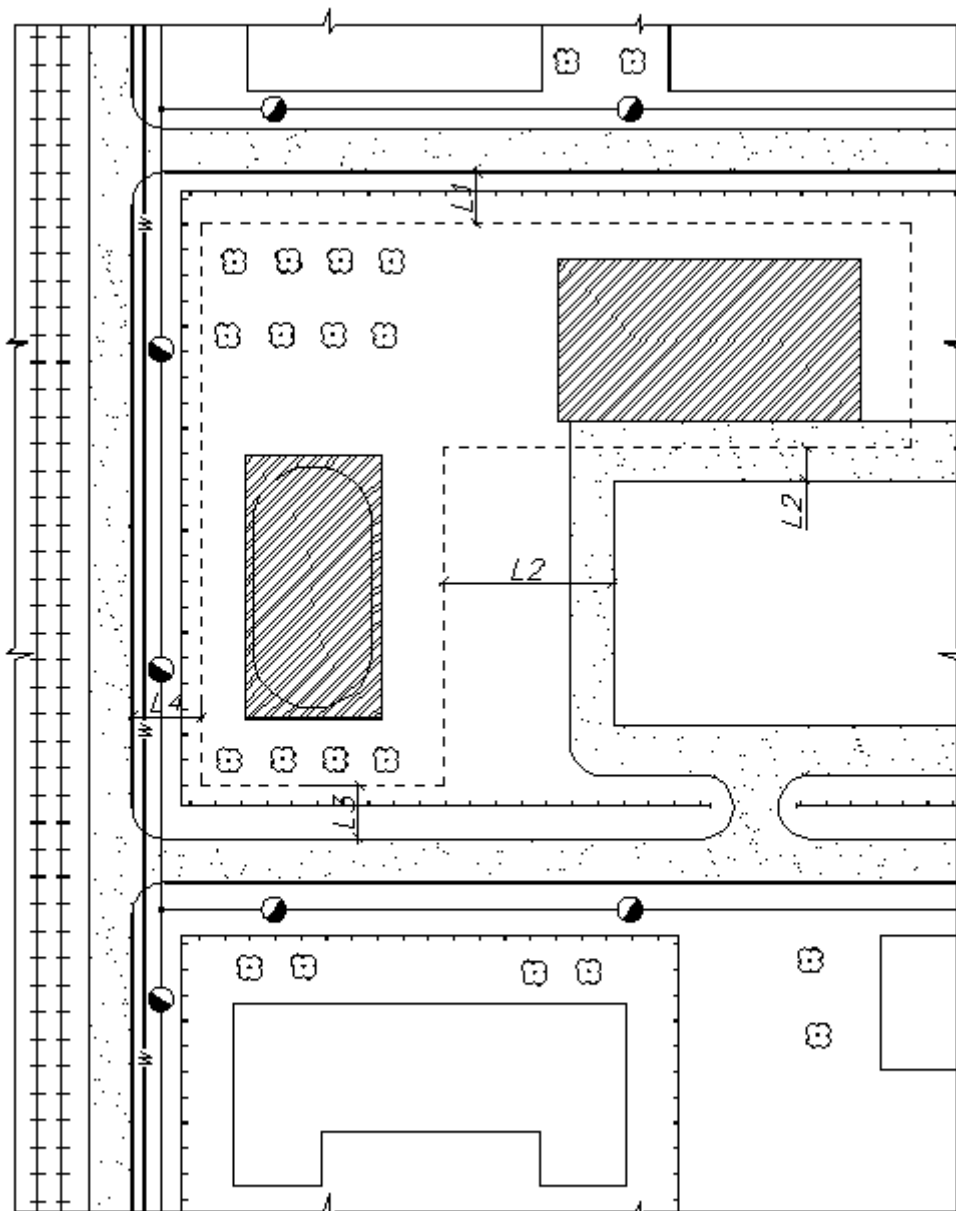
Схема Генплана многоэтажного здания (вариант2)
